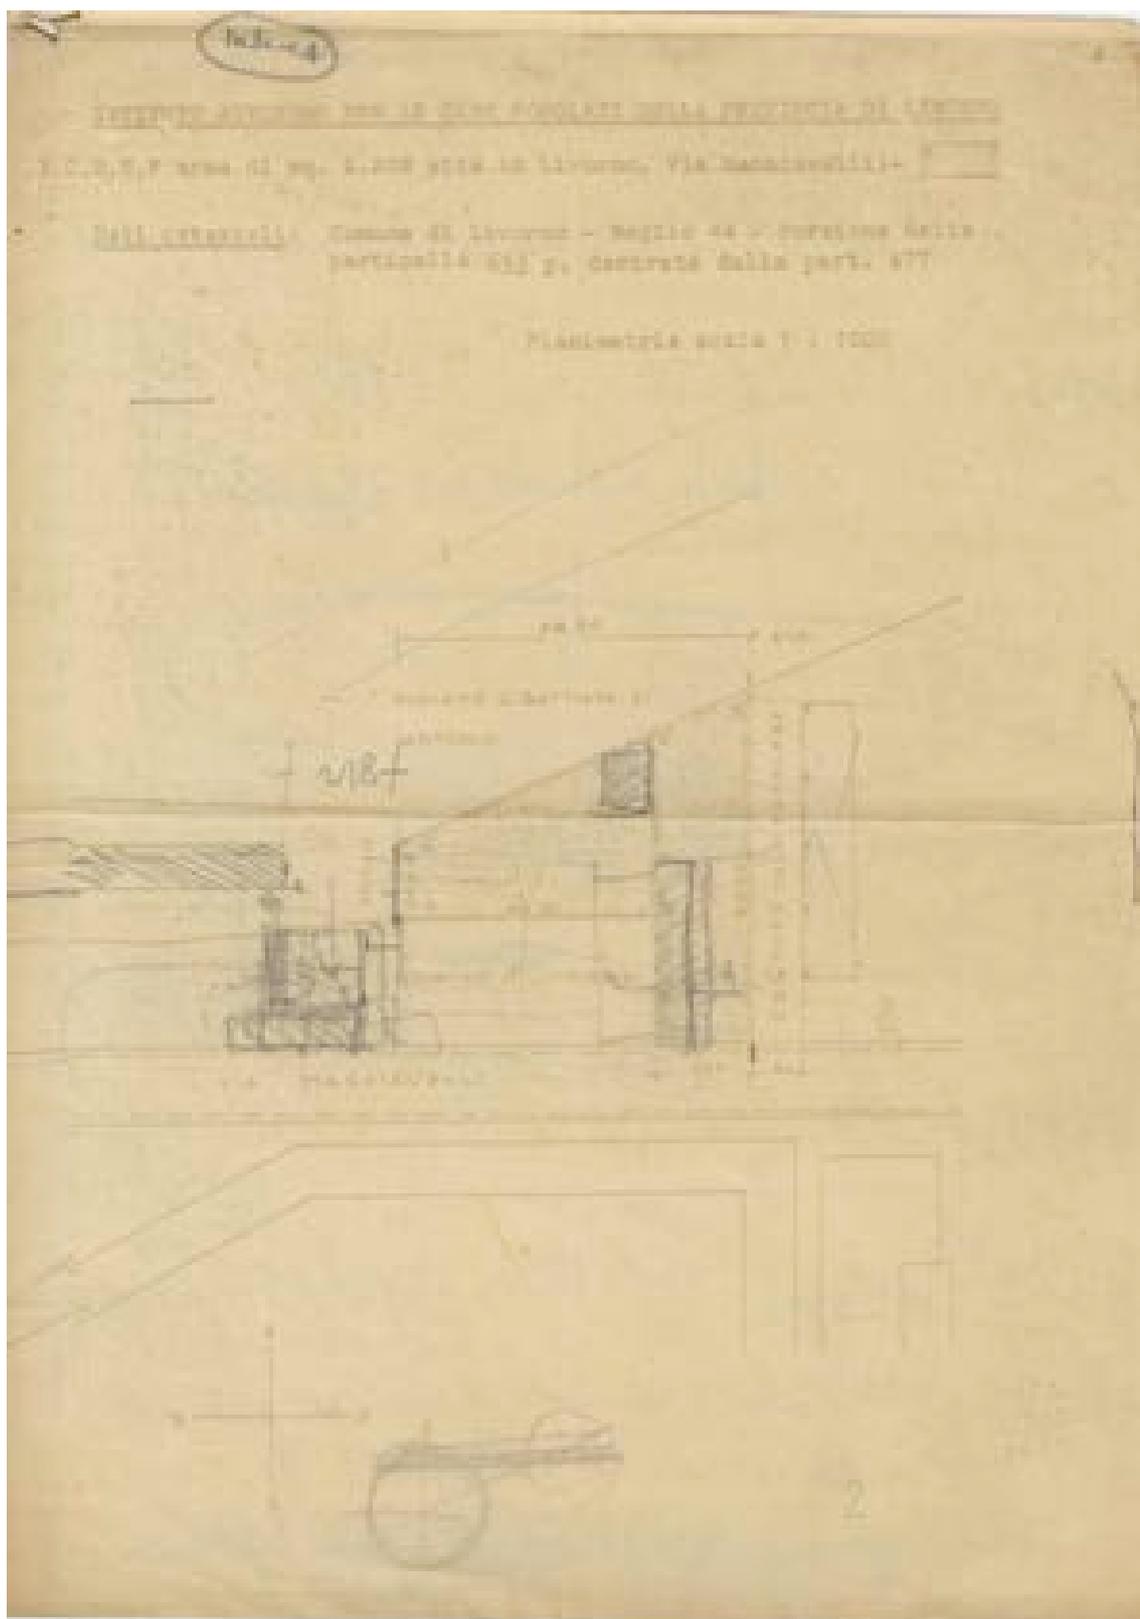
Rispetto distanze (AABS-1980_rispetto distanze)
